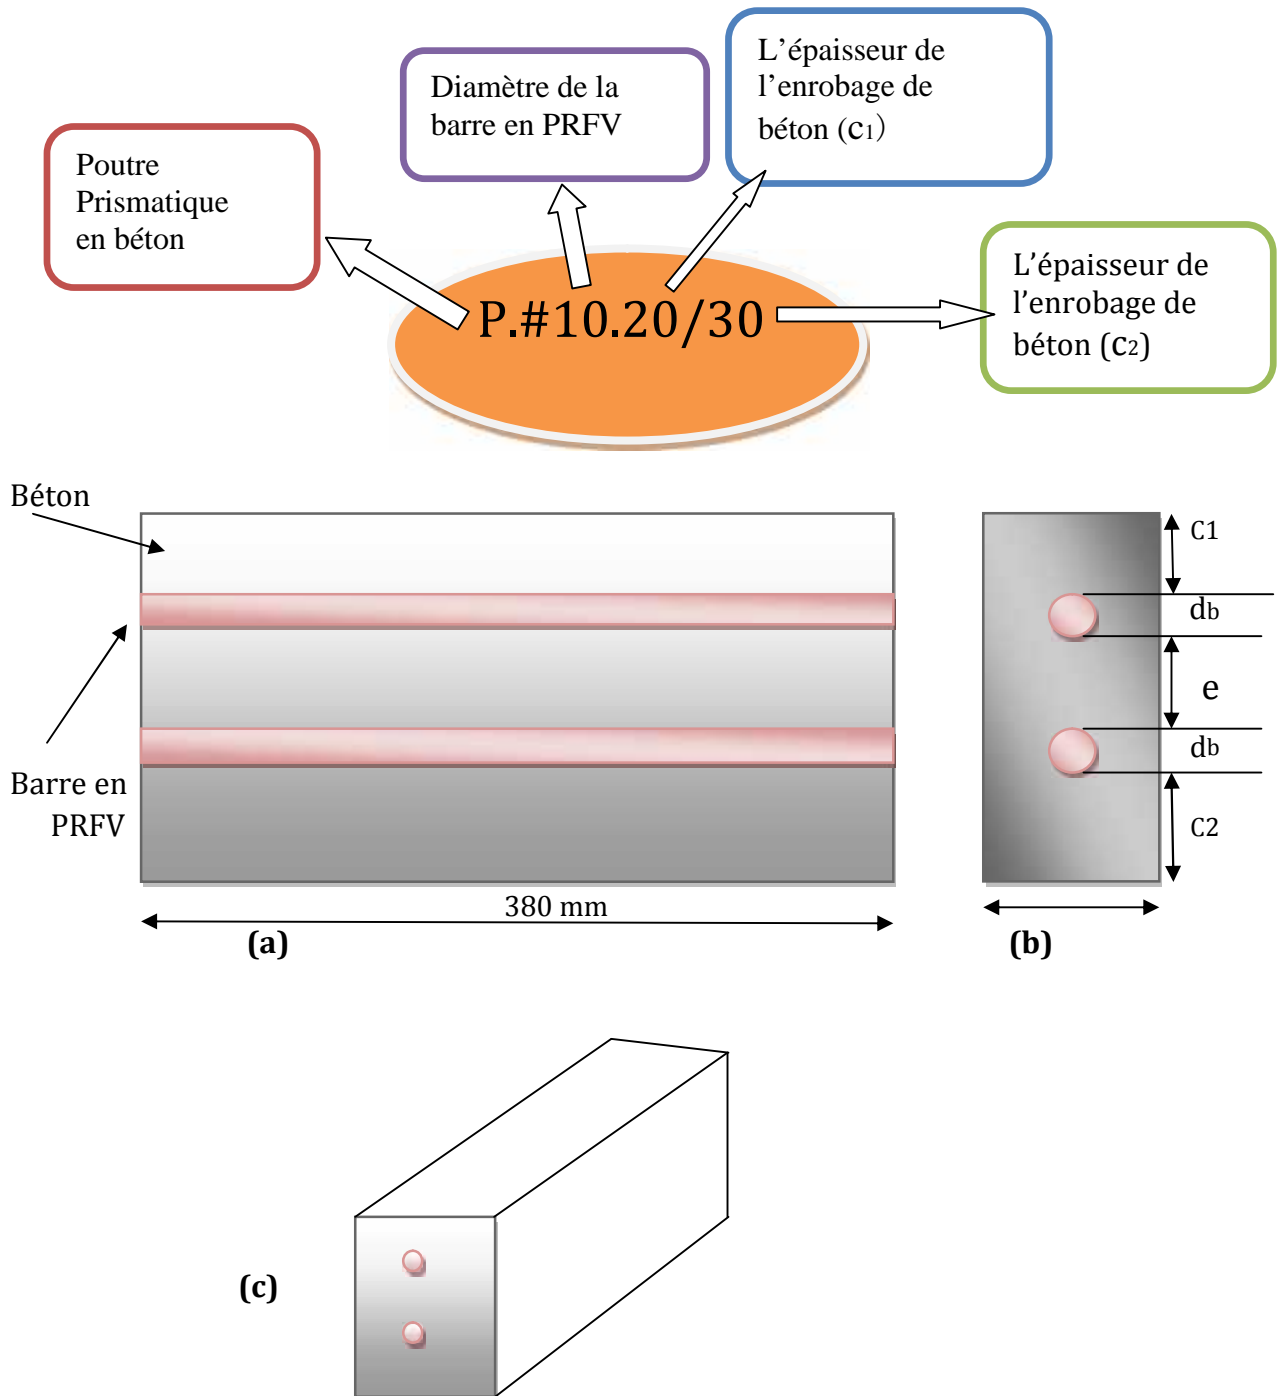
(a) Coupe en longue de la poutre P.#10.20/30, (b) Coupe en travers de la poutre P.#10.20/30, (c) Vue en perspective de la poutre.
